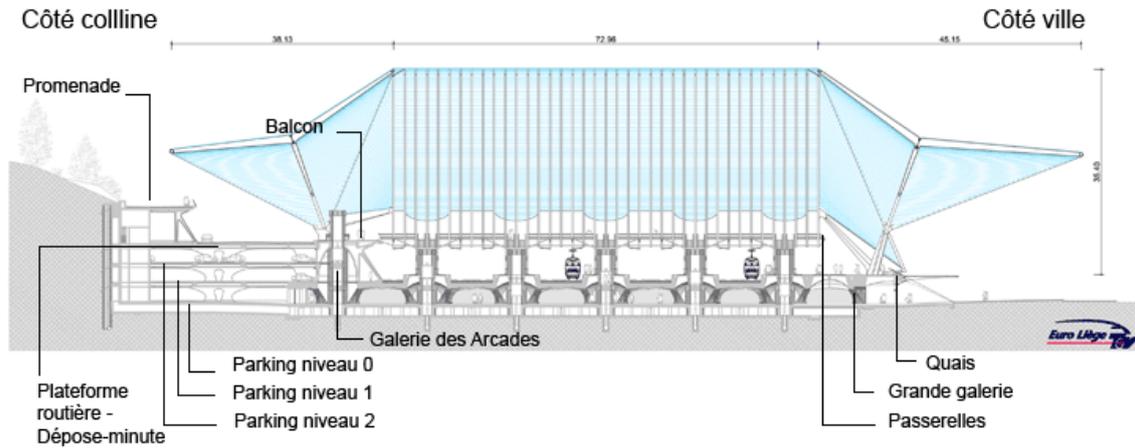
Coupe transversale de bâtiment de la gare Guillemins.
